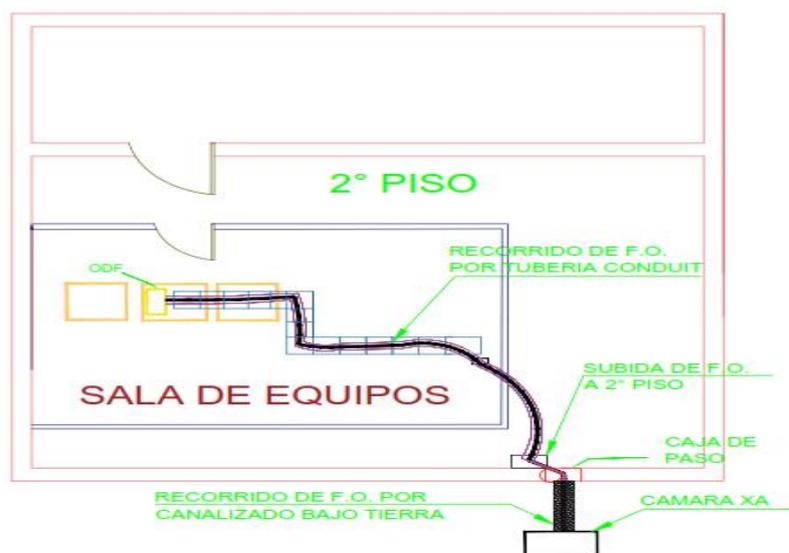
Plano de planta del recorrido del cable y equipo a instalar(ODF) en site García
